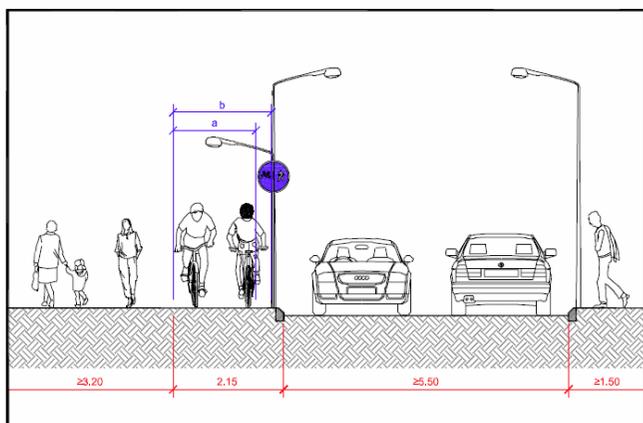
Piste ciclabili – Sezione tipo – Bidirezionale su marciapiede
